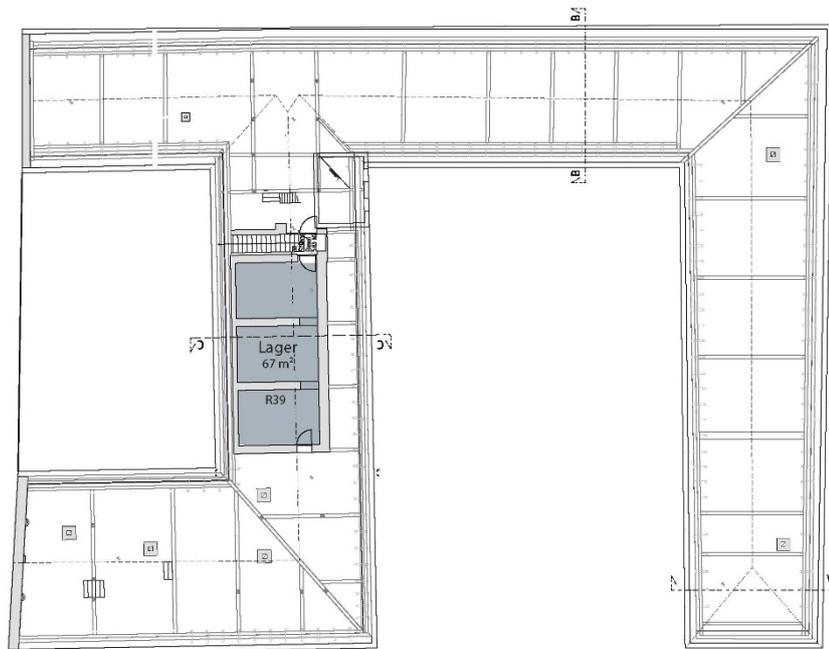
Nutzungsplan Grundriss Dachgeschoß
